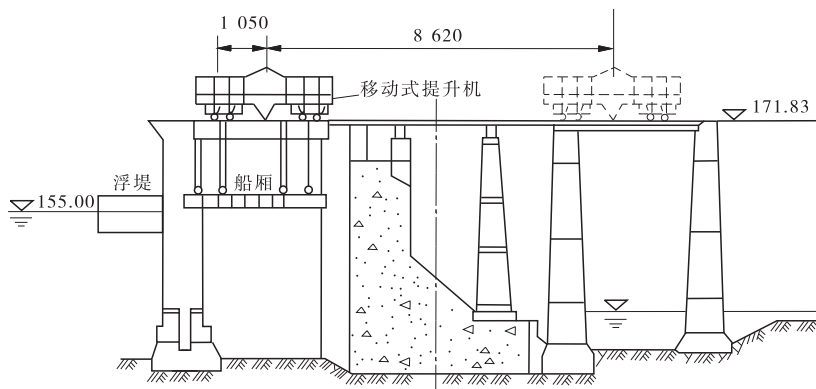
丹江口水利枢纽的垂直升船机 (高程单位:m;尺寸单位:cm)
